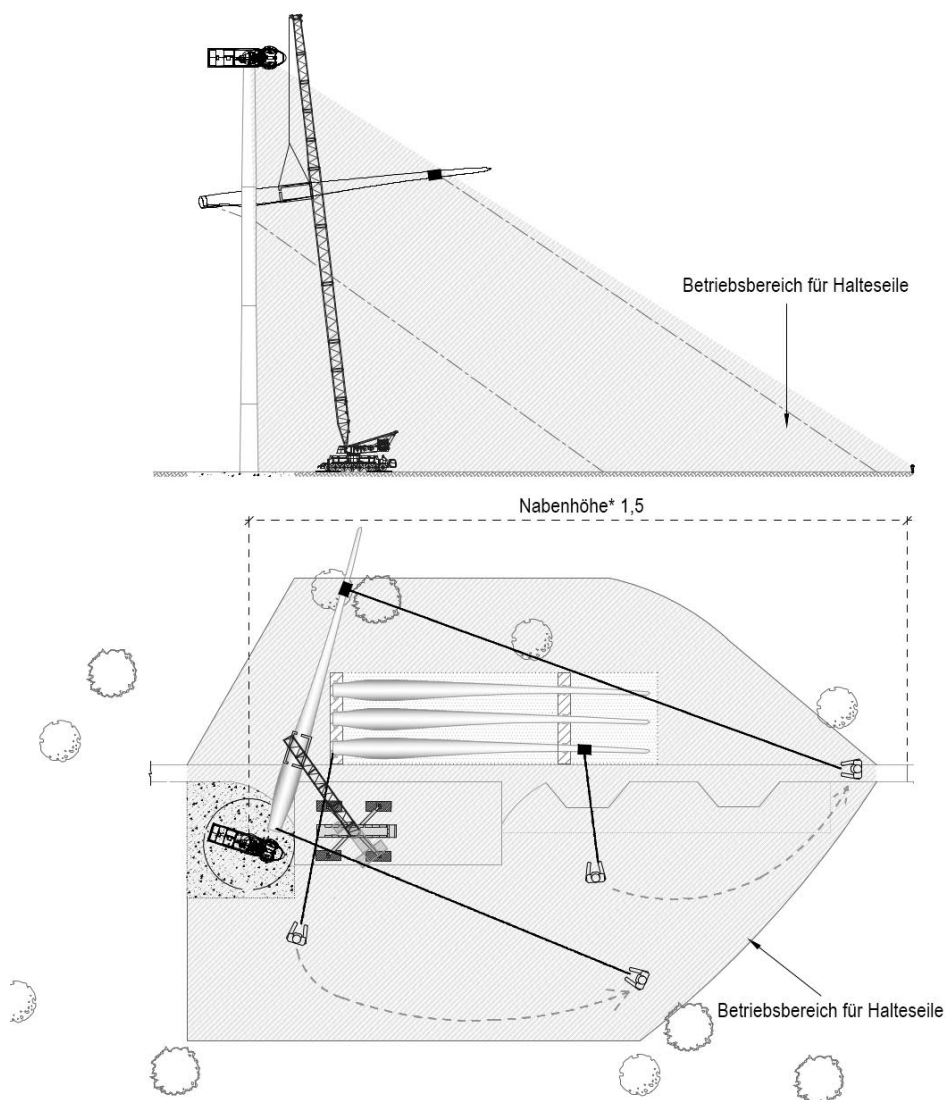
Beispielhafte Zeichnung des Flächenbedarfs für die Verwendung von Halteseilen bei der Einzelblattmontage.
